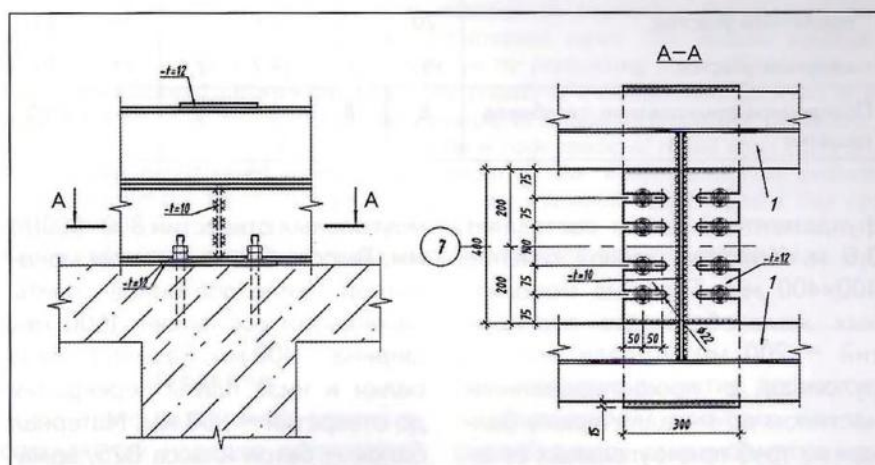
Узел крепления стальной балки к верху железобетонной балки, шаг 1 м (1 – балки 20К2)
